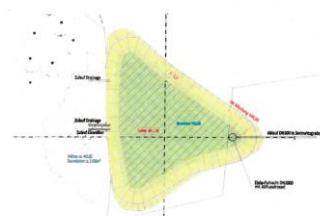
Planansatz Planr. E-LP-5.2 / Lageplan vom 19.09.2015
